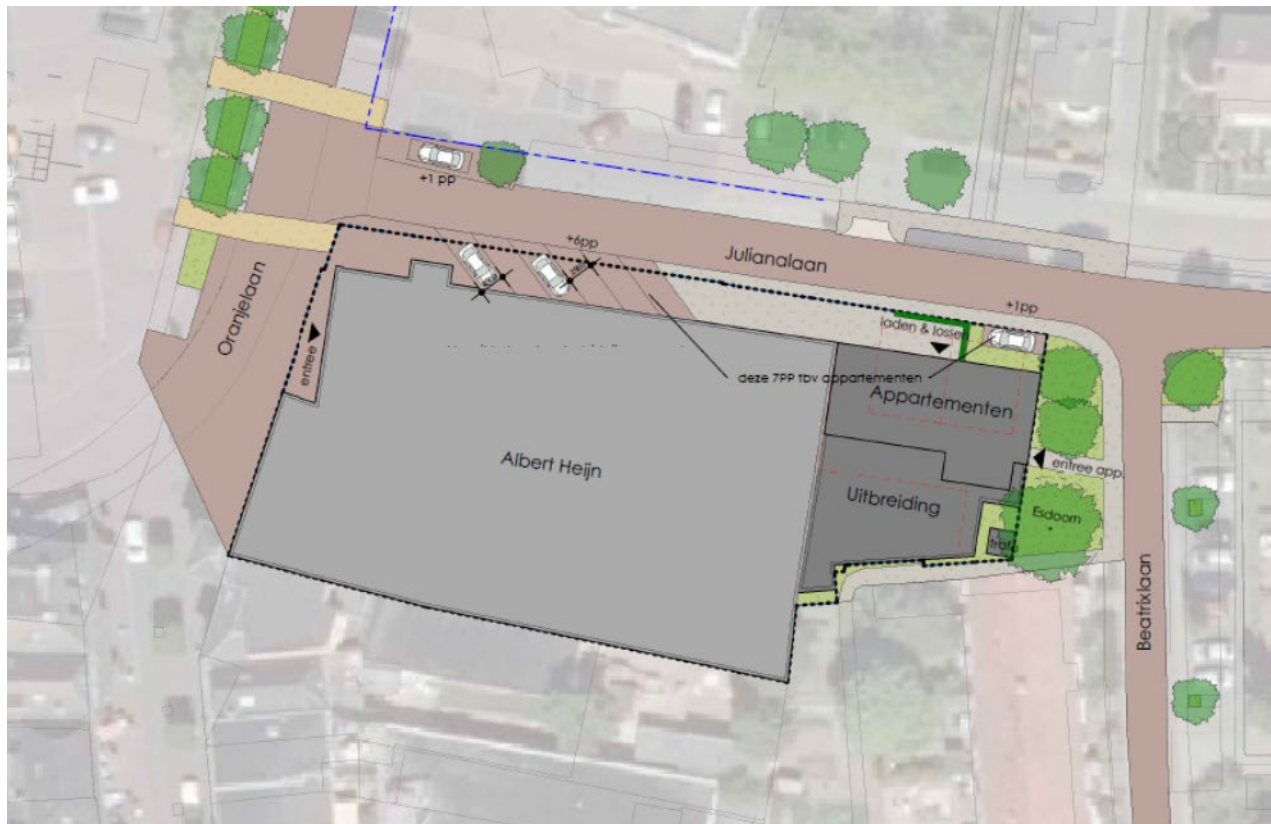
luchtfoto met aanduiding plangebied initiatief Oranjelaan 2, Wijhe
